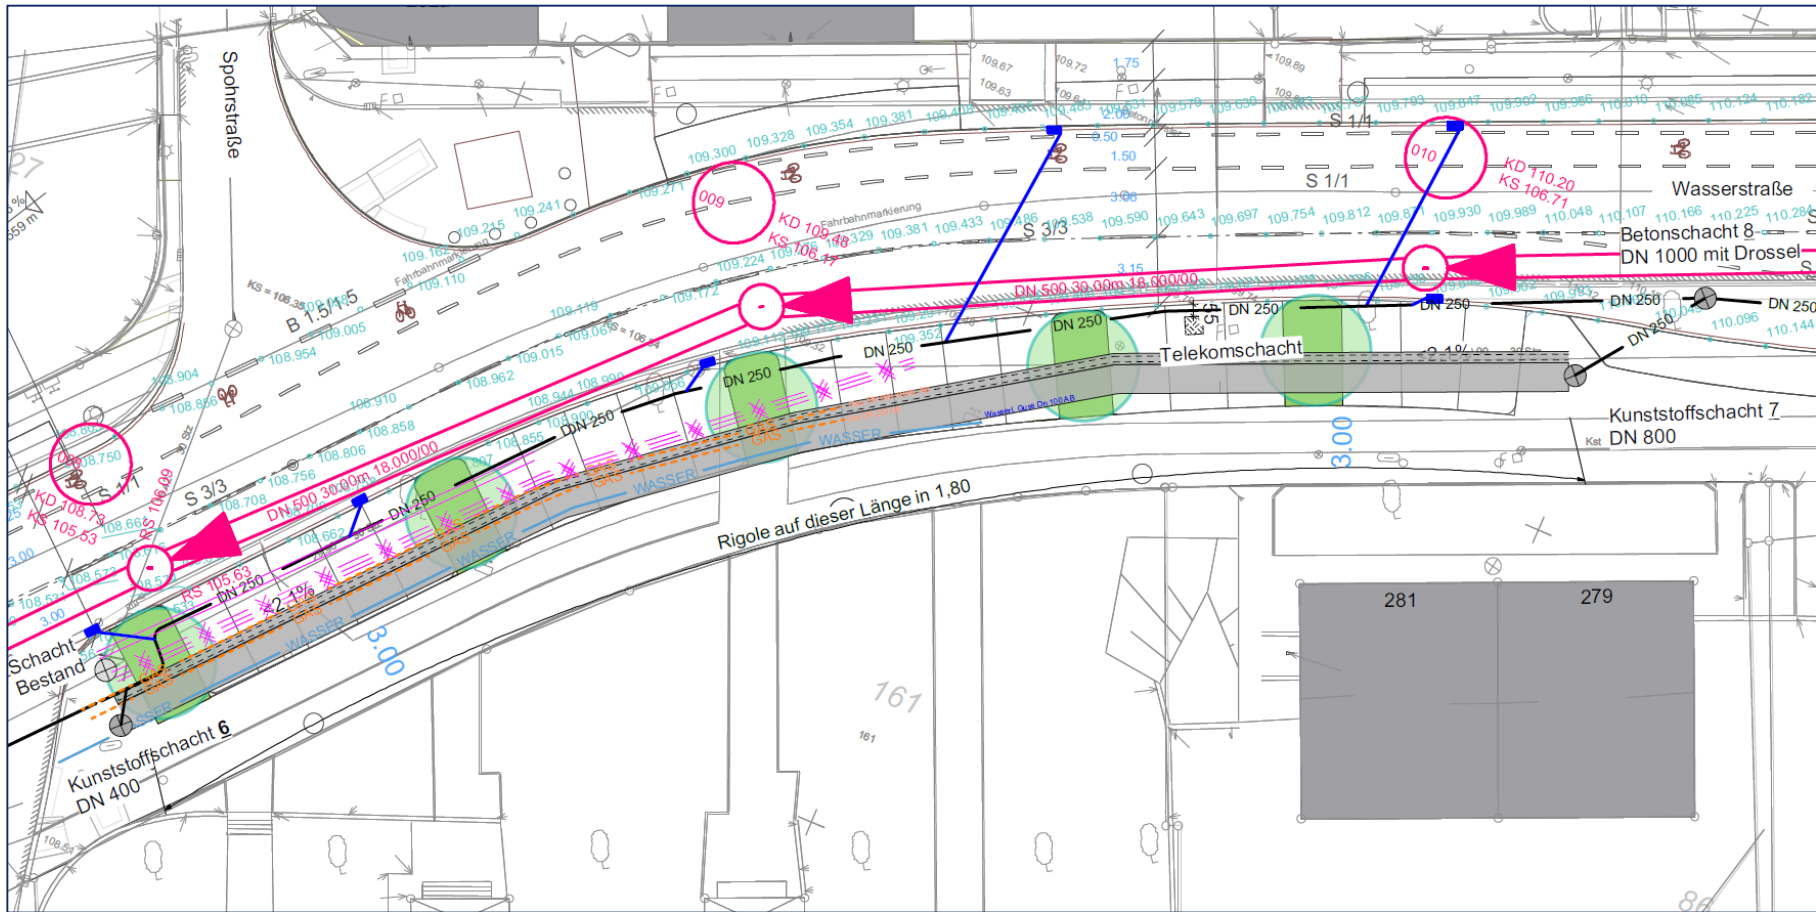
Ausschnitt Entwässerungslageplan mit vernetzten Rigolen
